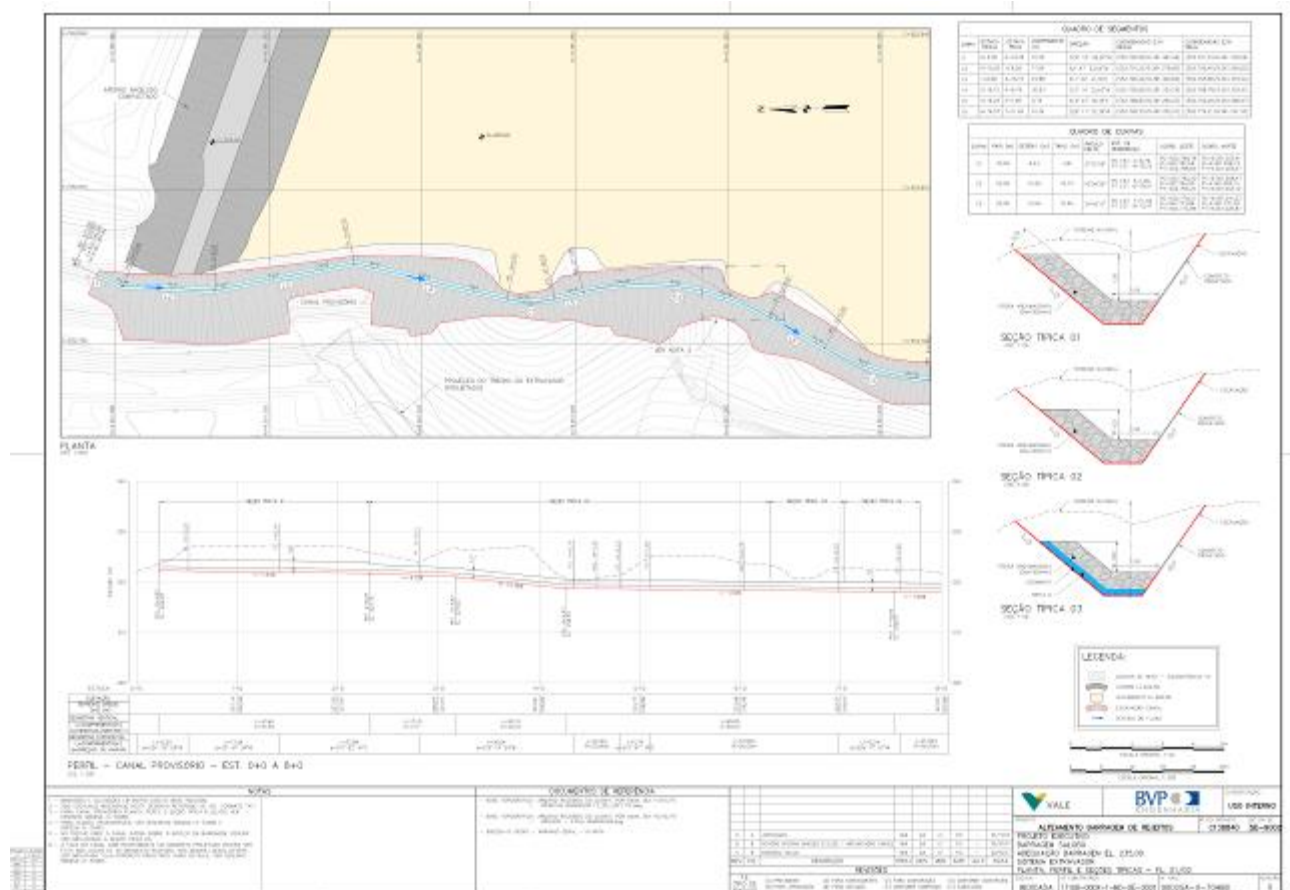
Planta e perfil longitudinal do extravasor da elevação 225,0 m.
